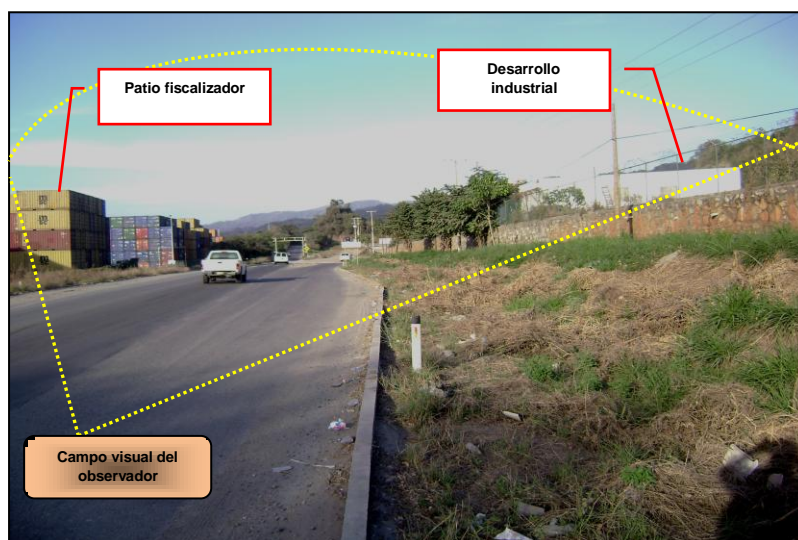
Vista de ambos lados de la carretera Manzanillo-Minatitlán en el tramo donde se construirá el puente
